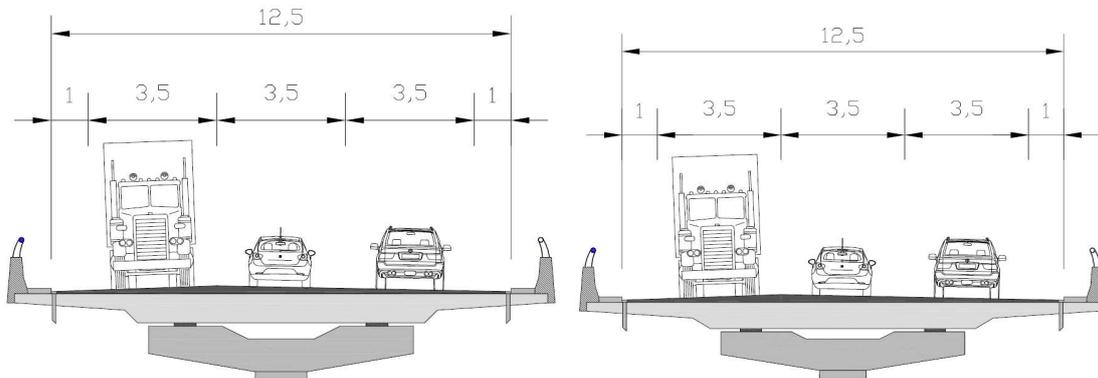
SECCIÓN TIPO PUENTE 5 (IZQDA) Y PASOS ELEVADOS (DCHA) (COTAS EN METROS)
